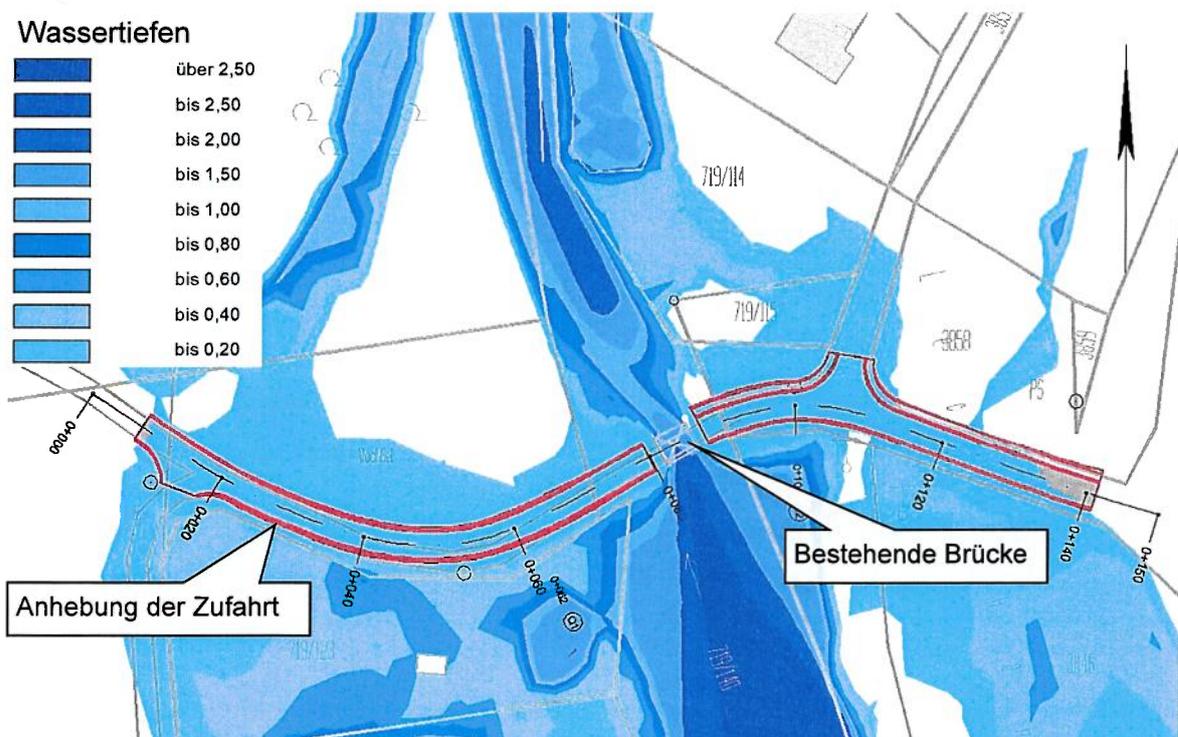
Ausschnitt aus Plan T 141 mit Überschwemmungssituation im Planzustand nach Anhebung der Zufahrt zum Kraftwerk Ellgau
